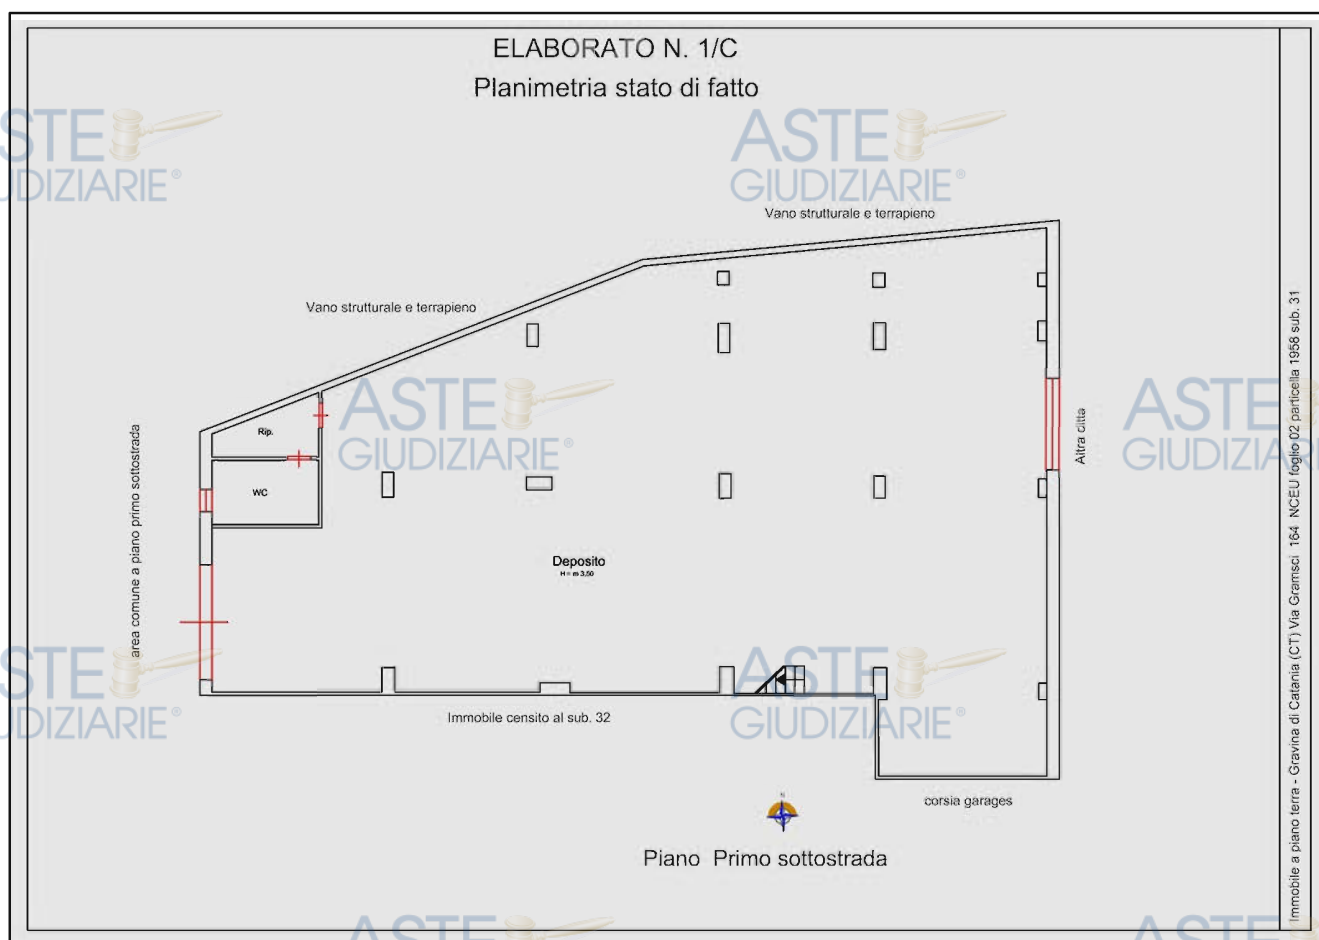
Visualizzazione della planimetria attuale dell'immobile a piano primo sottostrada contraddistinto con il sub. 31.
